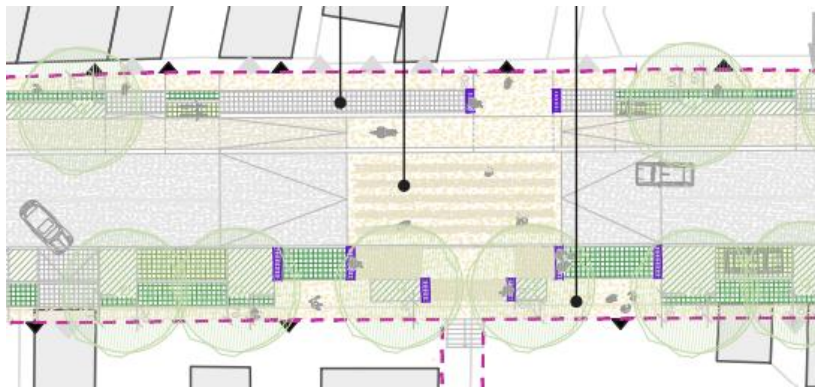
RD35Ter : Plan « placette » cité Saint-Germain
